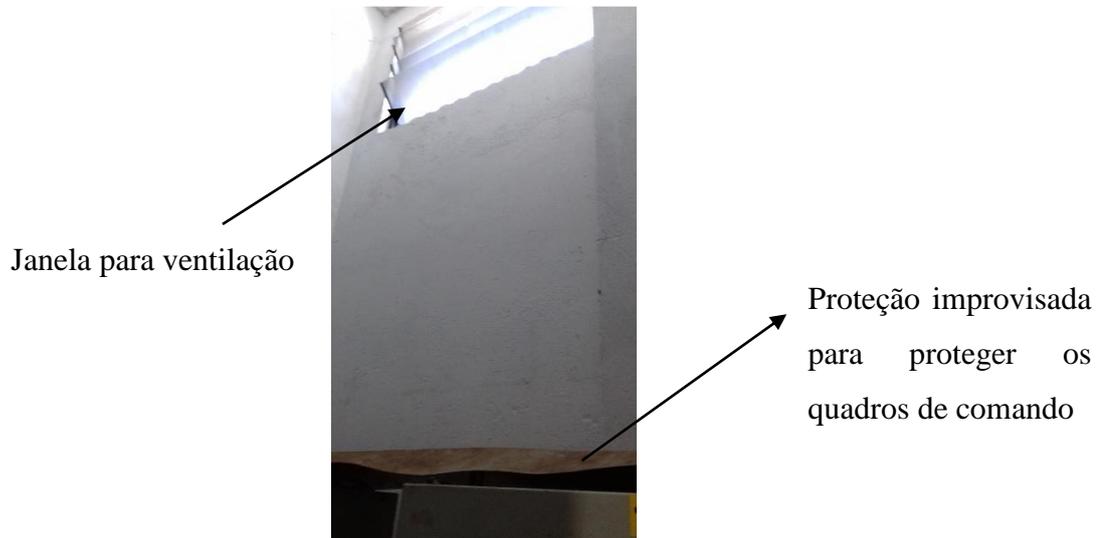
Janela para ventilação da casa de máquinas dos elevadores social.
